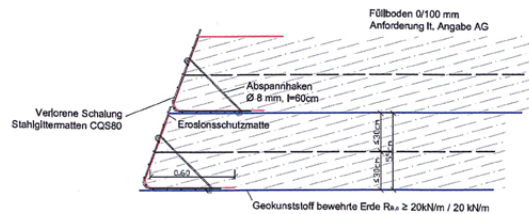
Konstruktionsdetail – geokunststoffbewehrter Erdkörper in Polsterbauweise
